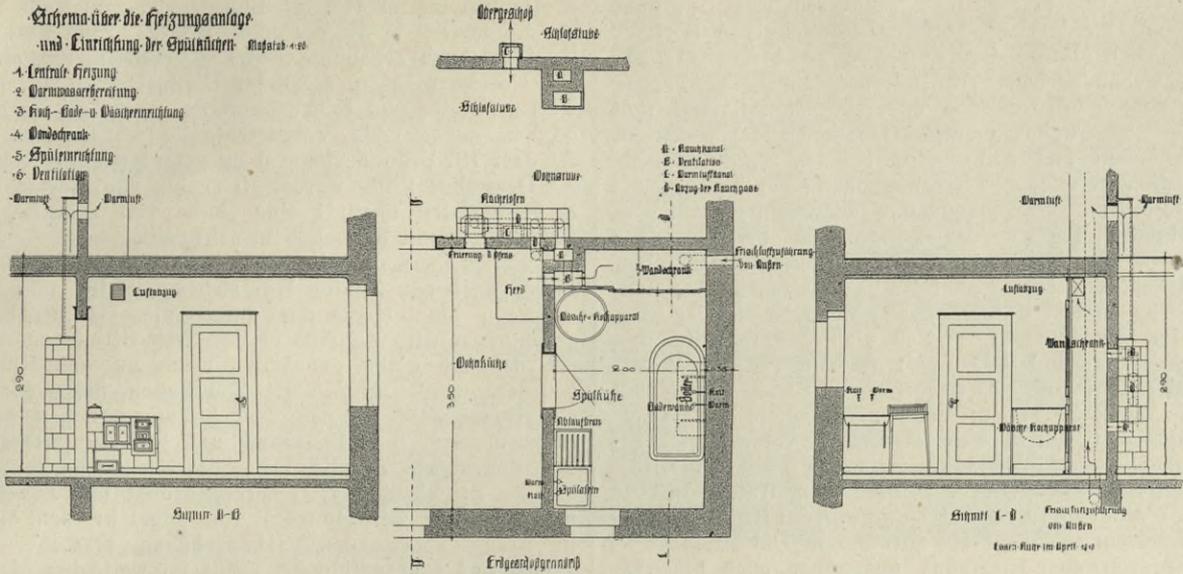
bis 238. Spülküchenanlage in den Gebäuden der Gartenstadt Margarethenhöhe
